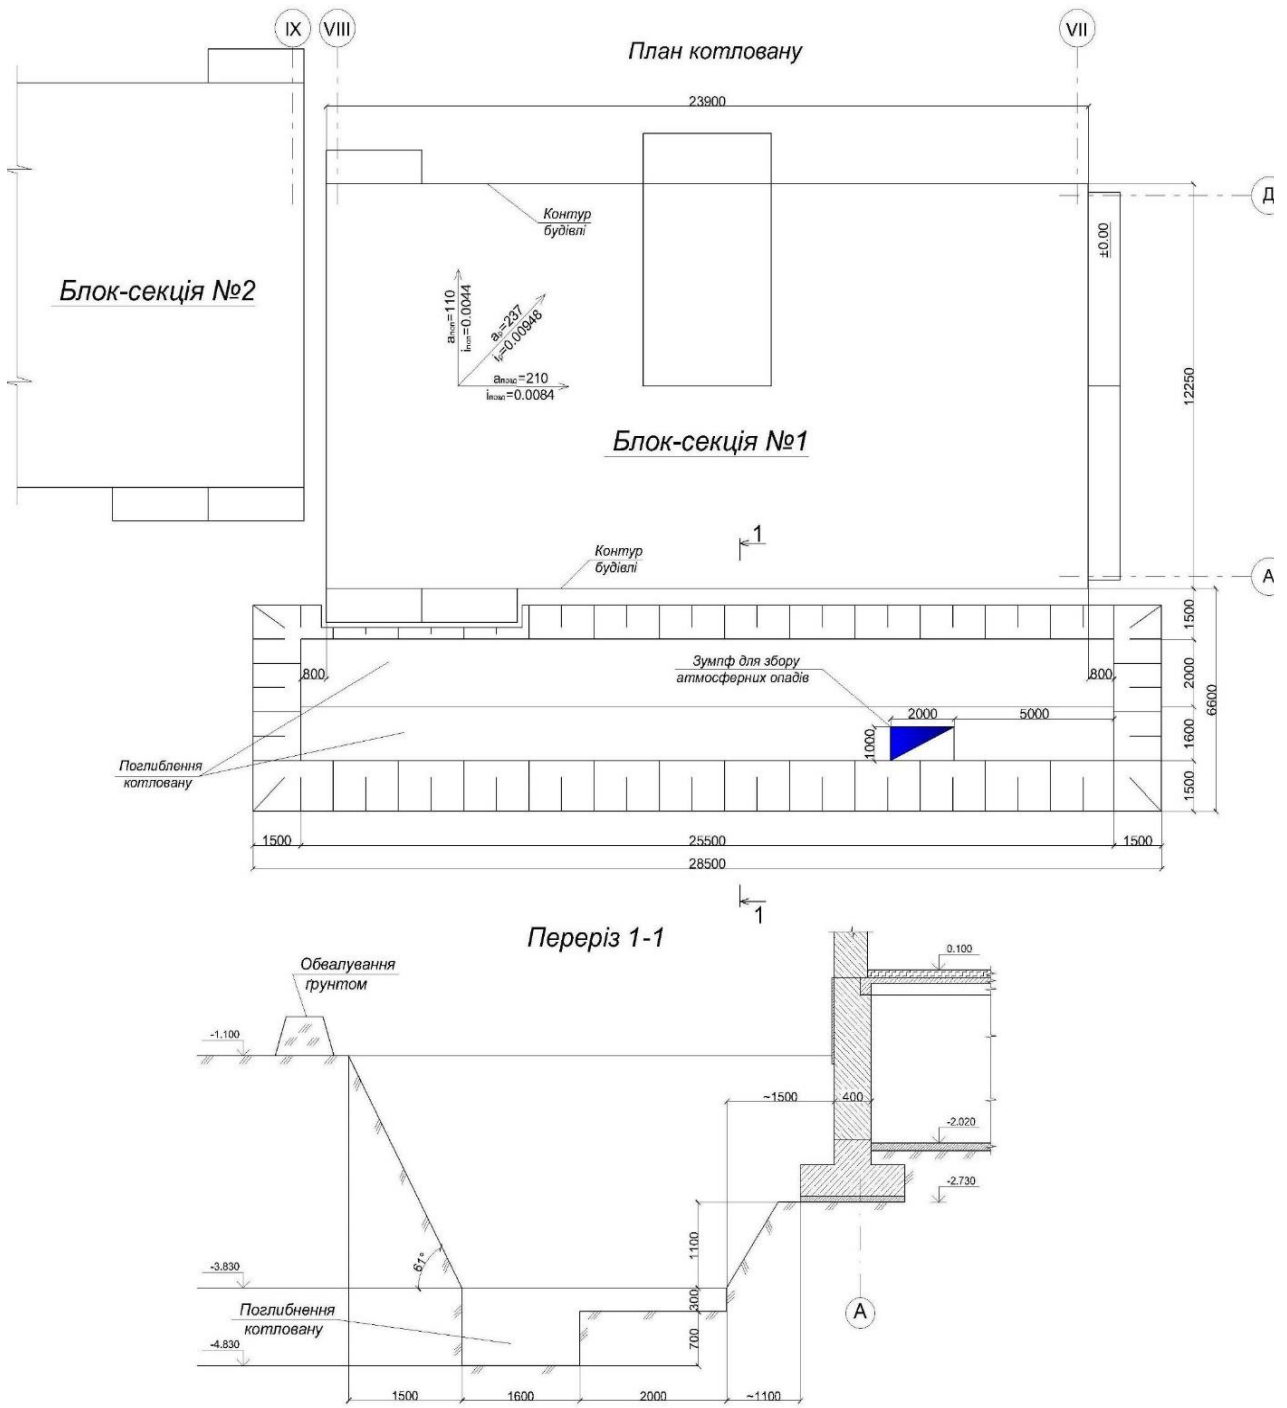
План котловану та переріз 1 – 1 по ньому.
